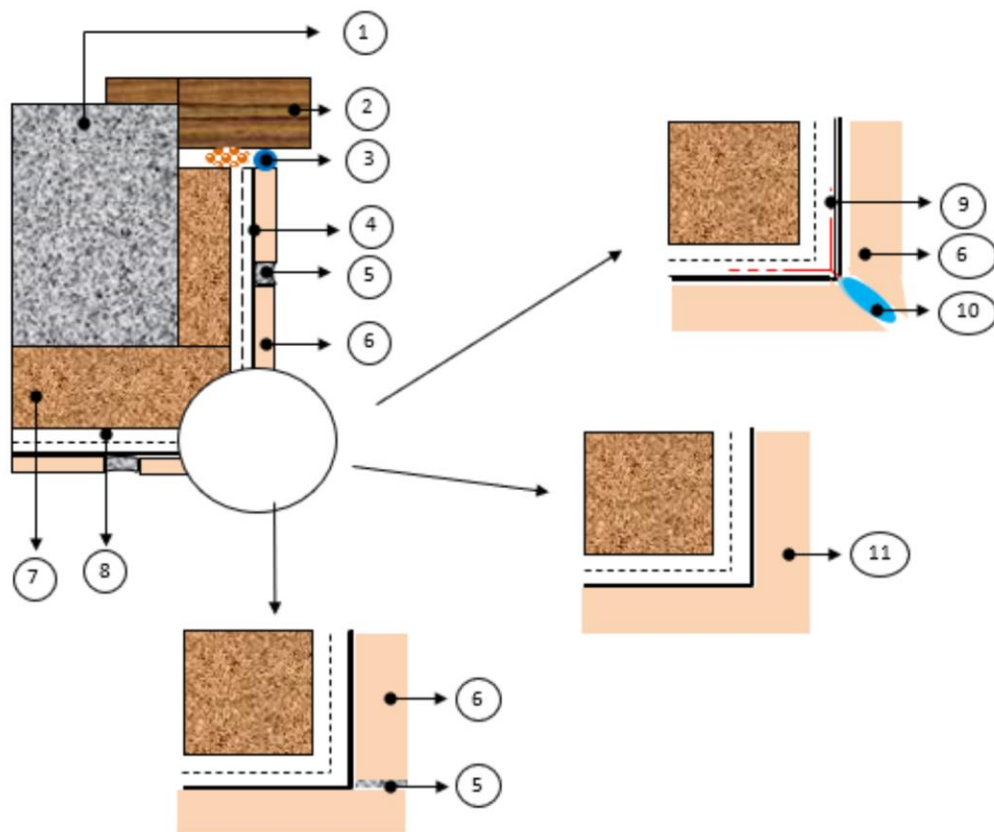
Plans de chevillage dans le cadre des finitions plaquettes de parement en terre cuite
